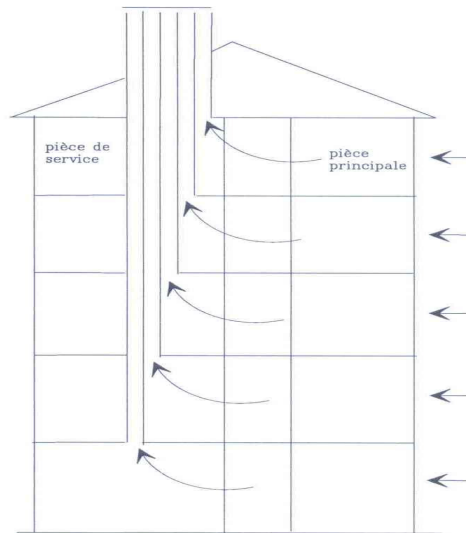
Ventilation par conduits à tirage naturel, détails des types de conduits.
